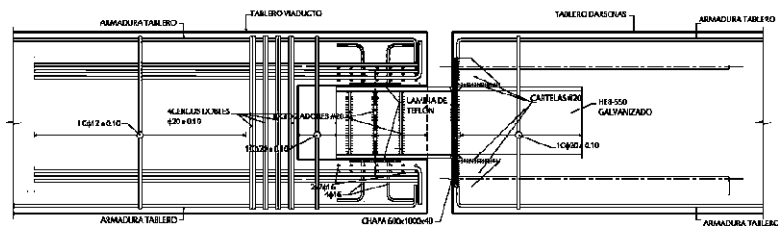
Junta de dilatación, en voladizo en el centro de vano, entre la dársena superior y los viaductos de acceso.
